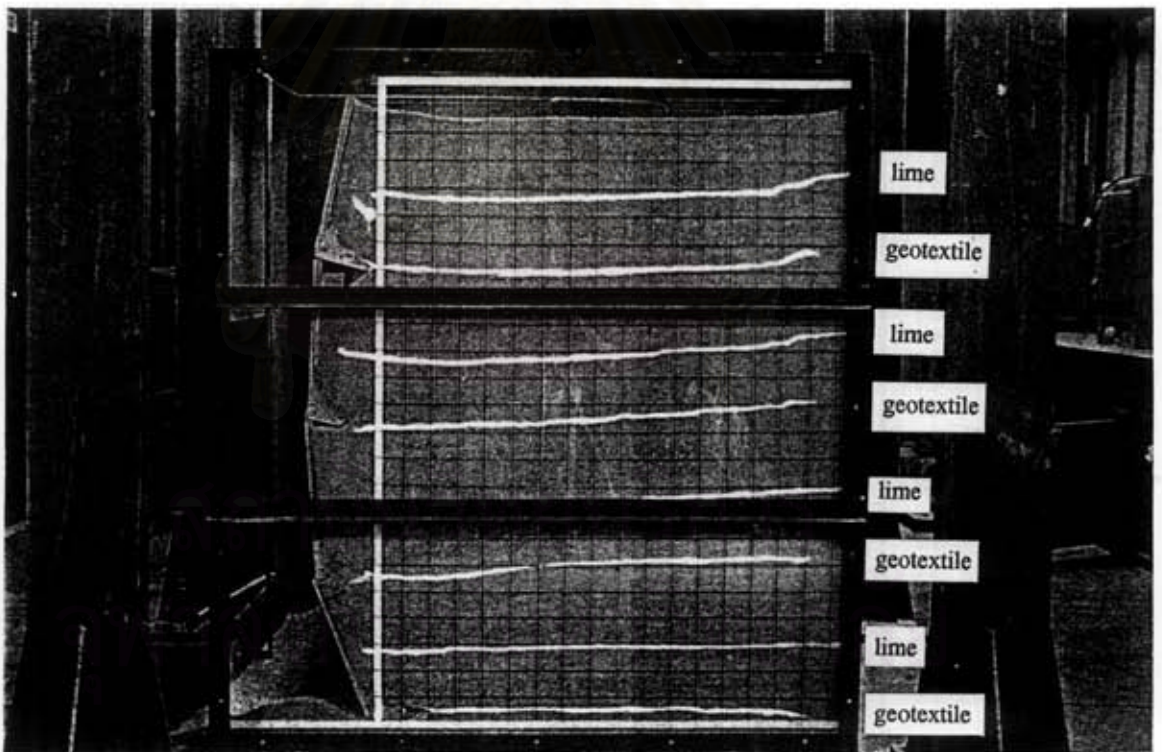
ลักษณะของ Failure Plane ที่เกิดขึ้นในกรณีการทดสอบที่ 1 (GT4-30-60)
